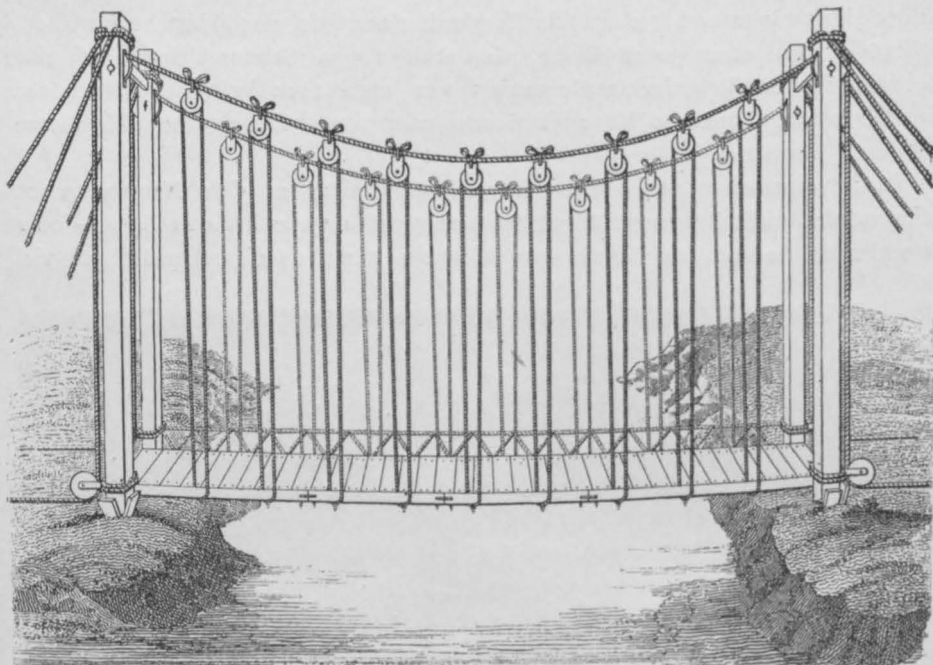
Seilbrücke mit angehängter Bahn nach FAUSTUS VERANTIUS. 1617.
